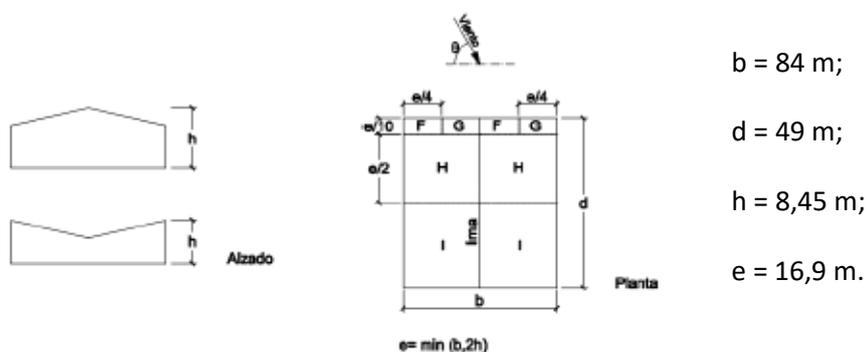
ACCIÓN DEL VIENTO CON DIRECCIÓN LONGITUDINAL A LA CUBIERTA
